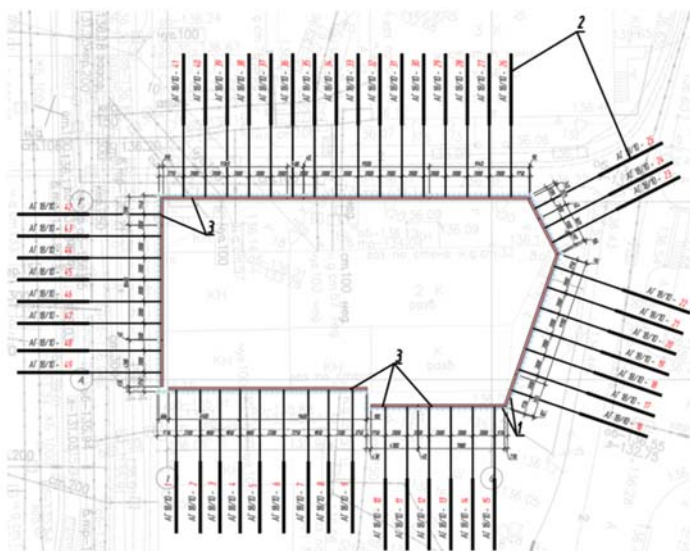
Схема размещения грунтовых анкеров ЭРТ ограждения котлована: 1 – буроинъекционные сваи ЭРТ; 2 – грунтовые анкера ЭРТ первого уровня; 3 – монолитный железобетонный обвязочный пояс
